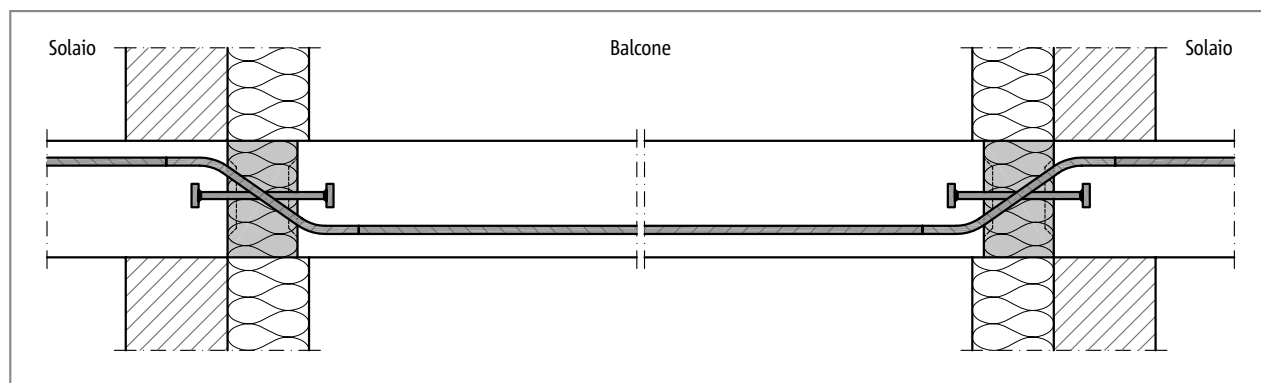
Schöck Isokorb® tipo QPXT: caso specifico loggia
